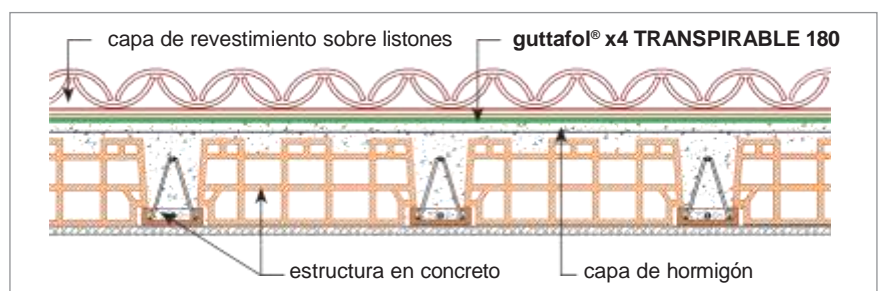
guttafol® x4 TRANSPIRABLE 180 colocado directamente sobre la capa de hormigón sin cámara de ventilación
